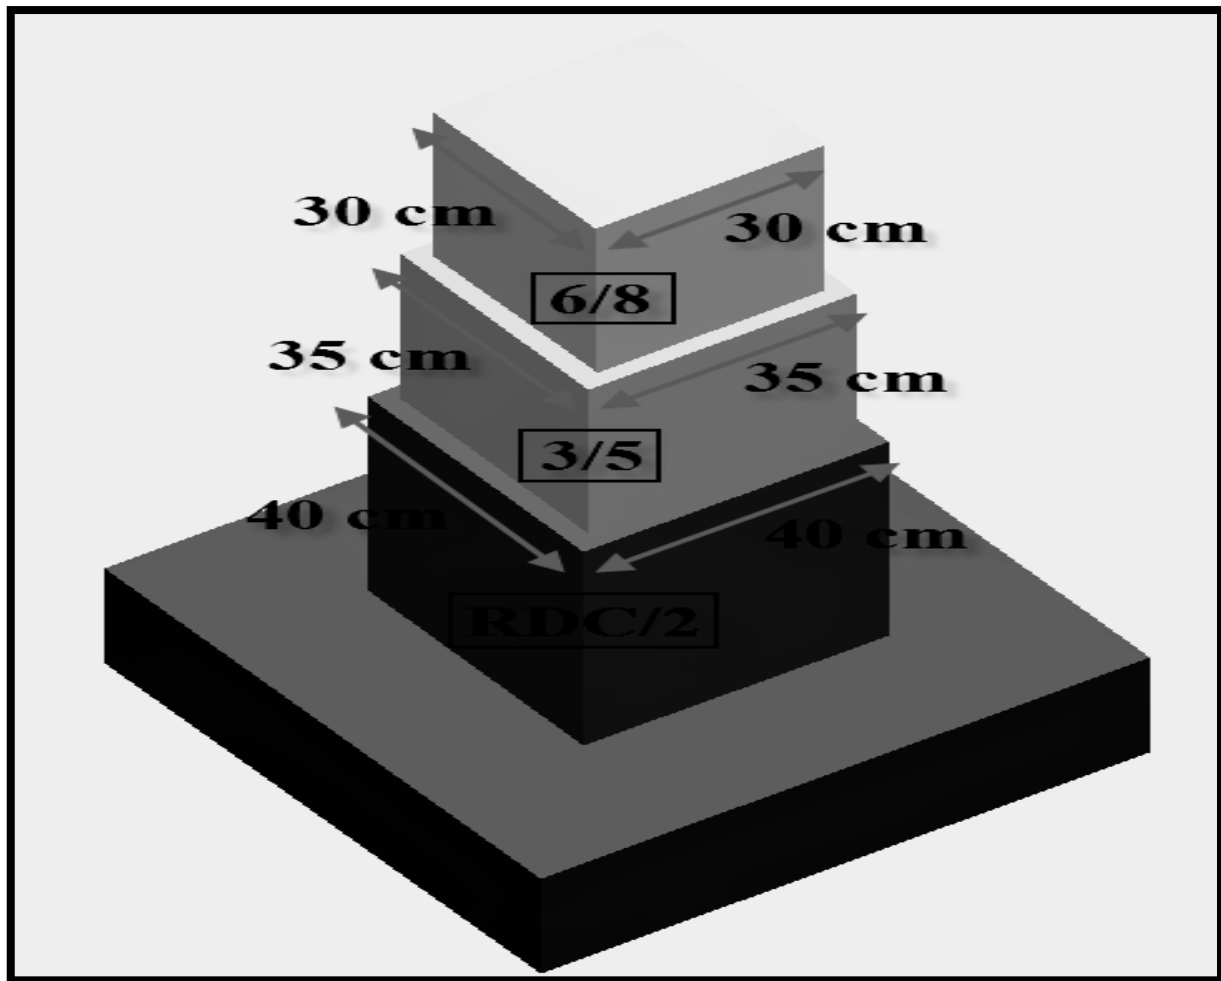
Schématisation (3D) des sections adoptées pour les poteaux.
